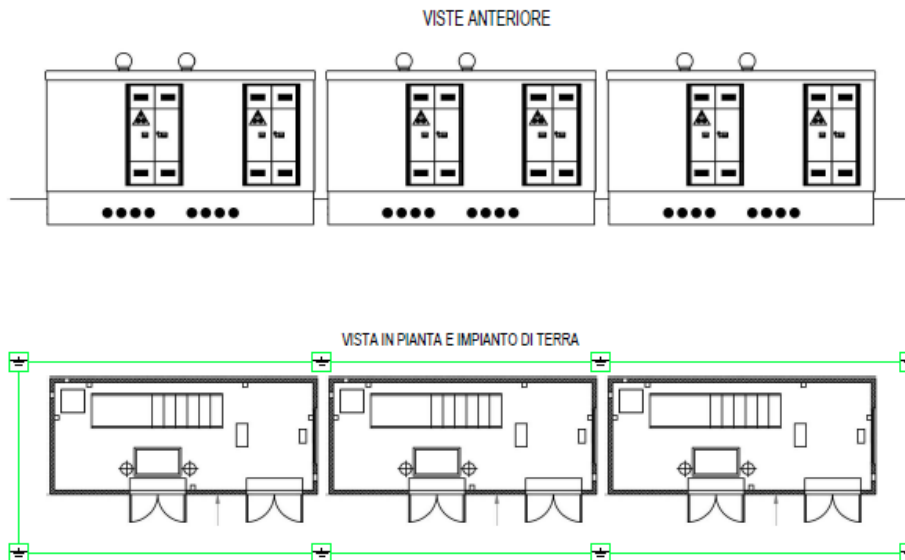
Pianta e prospetto cabine di sezionamento
